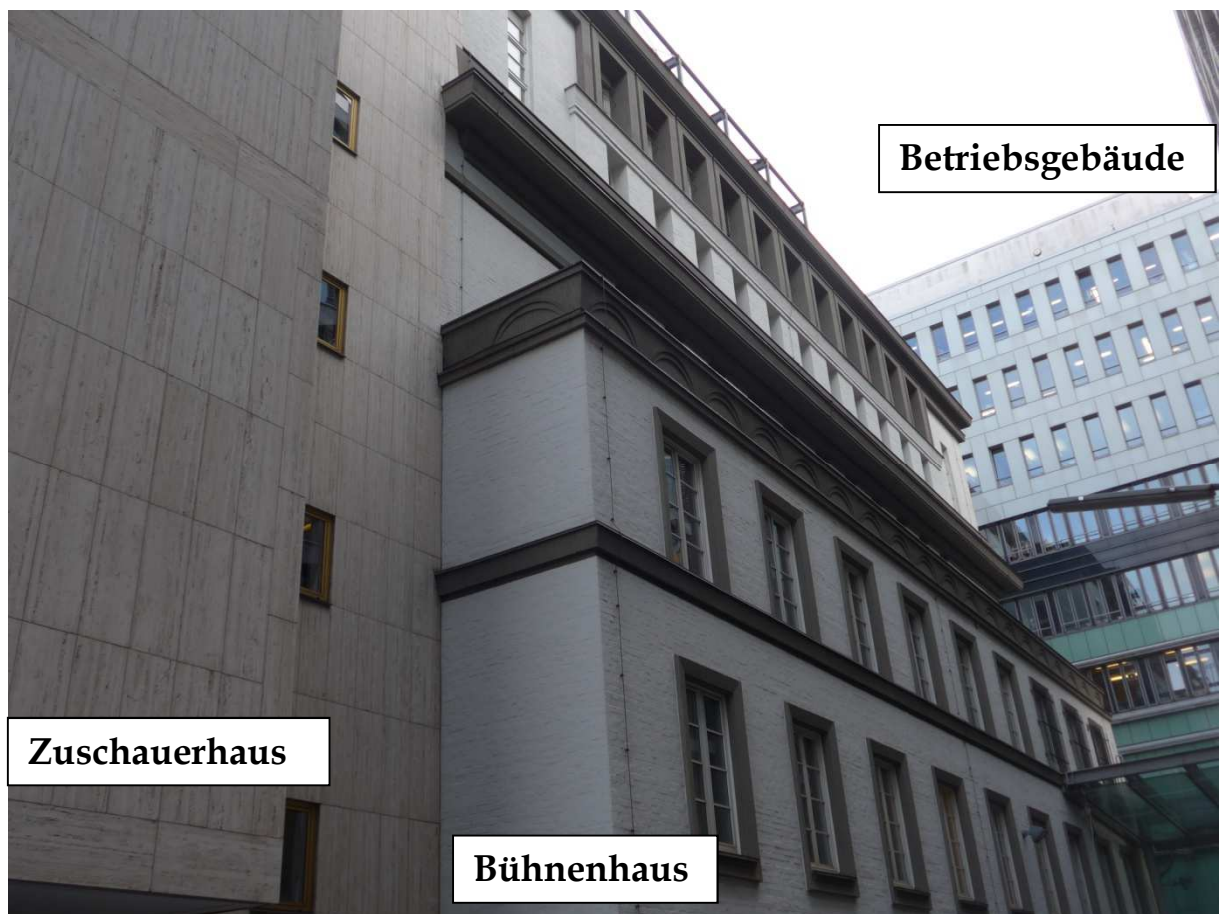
Fassaden Zuschauerhaus, Bühnenhaus und Betriebsgebäude
